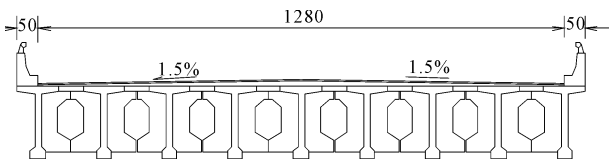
主桥 3 × 30 m T 梁桥横断面示意图 (单位: cm)
